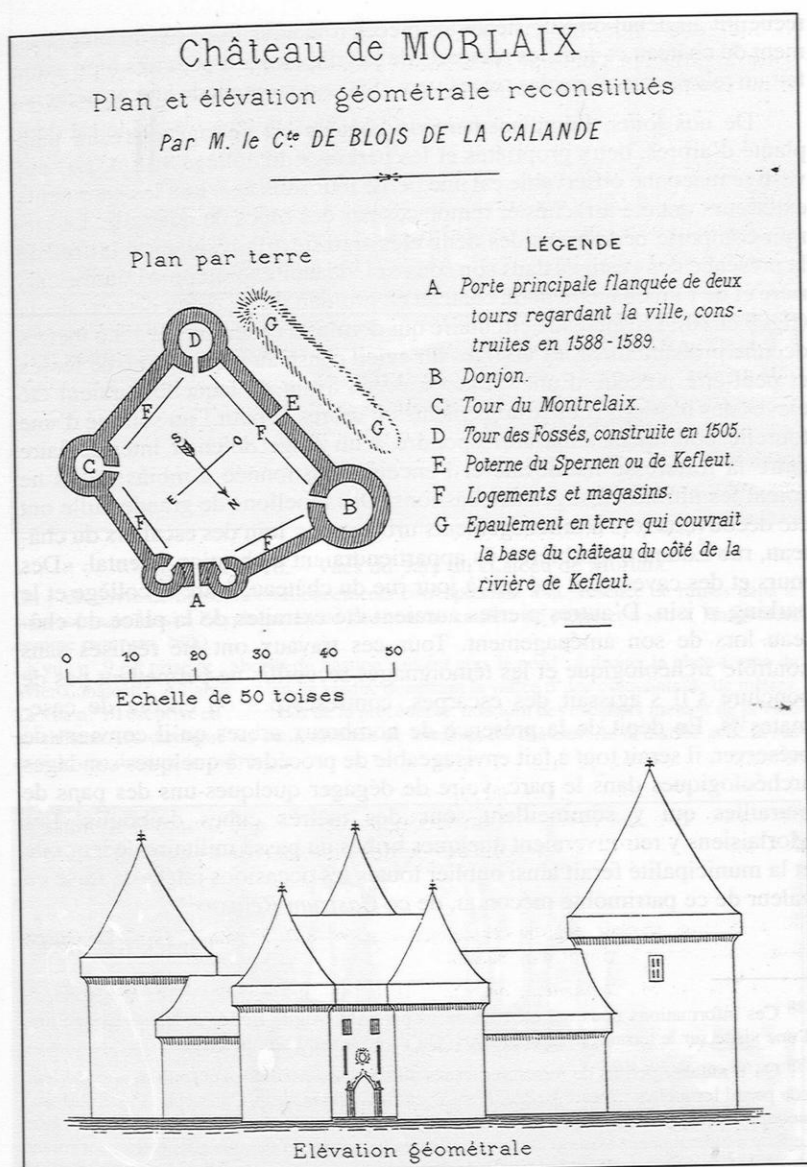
Plan et élévation du château par Aymar de Blois de La Calande.
